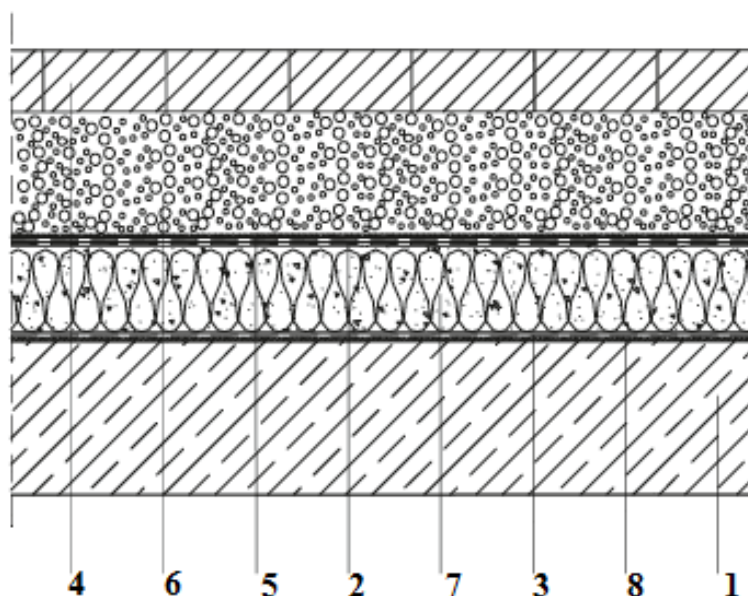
Конструкция с мостовой из комбинированного кирпича на гравийном основании: 1 — железобетонное перекрытие; 2 — гидроизоляция кровли, 2-слойная; 3 — кровельный материал, предотвращающий диффузию; 4 — бетонный блок (мостовая из комбинированного кирпича); 5 — разделительный или защитный слой; 6 — фильтрующий слой (мелкий щебень или песок в соответствии со статическим расчетом); 7 — изоляция плоской кровли Multipor DAA, уложенная на горячий битум; 8 — грунтовка
